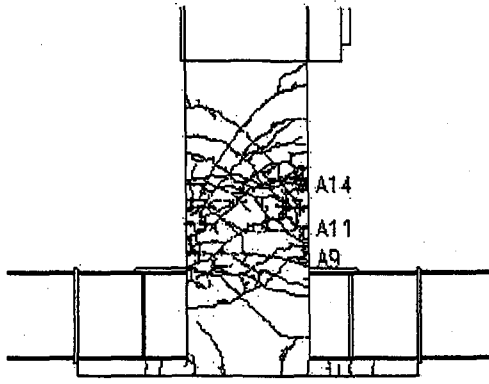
TYPE 1-3 最終時橋脚ひび割れ状況
